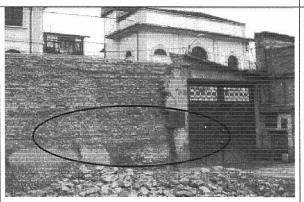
Vista cara posterior del muro de cerramiento, fisuras a media altura
